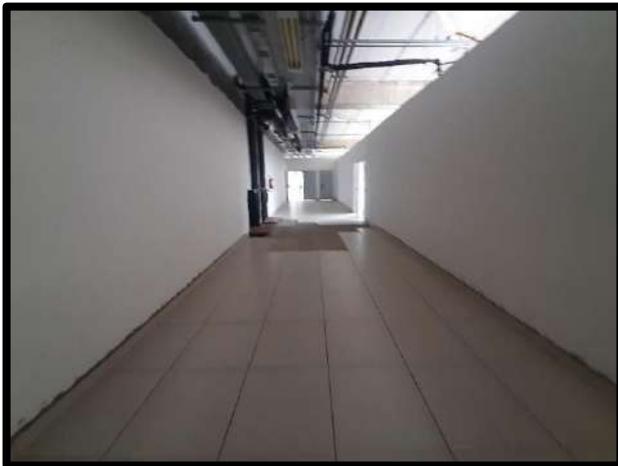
CIRCULAÇÃO DO 5º PAVIMENTO
